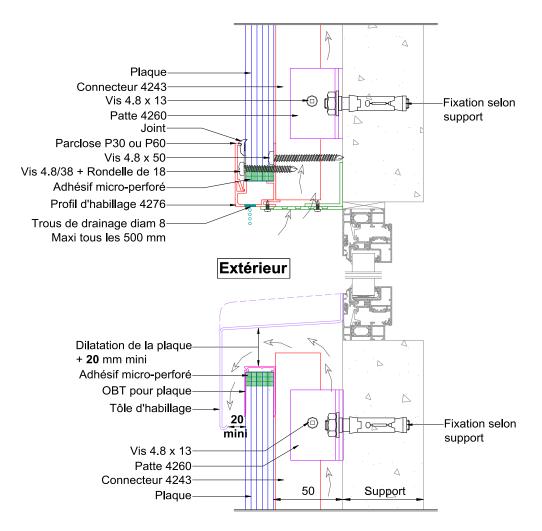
Encadrement d'une baie en feuillure - Coupe verticale
